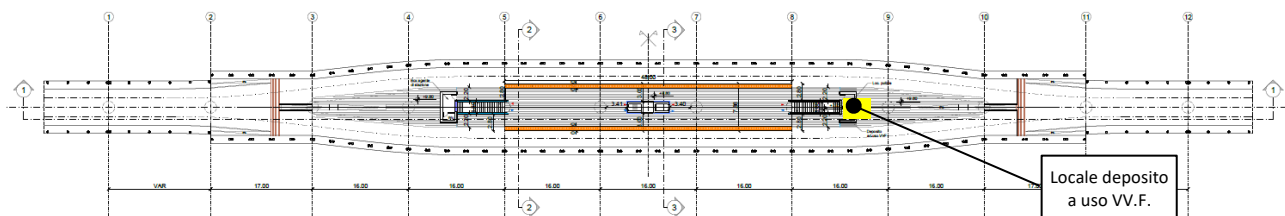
Pianta tipologica stazione piano banchina e locale VV.F.
